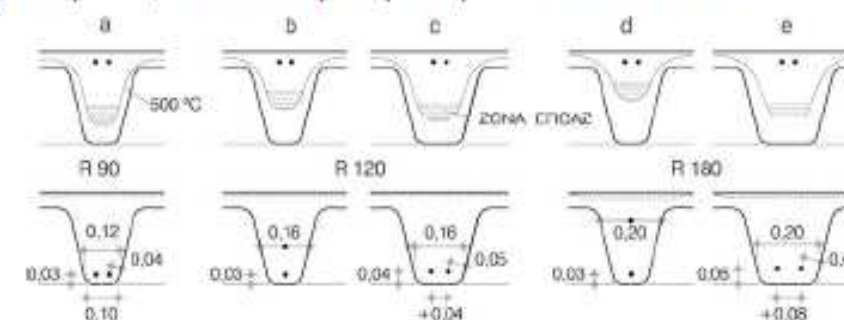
Secciones eficaces a incendio en forjado de casetones
